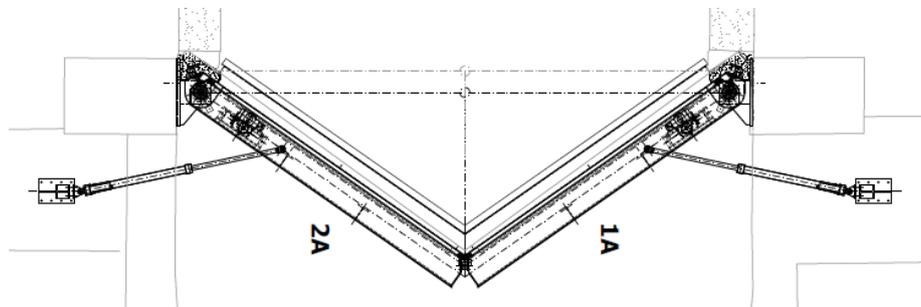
installazione cilindro elettromeccanico su porta 1A-2A
